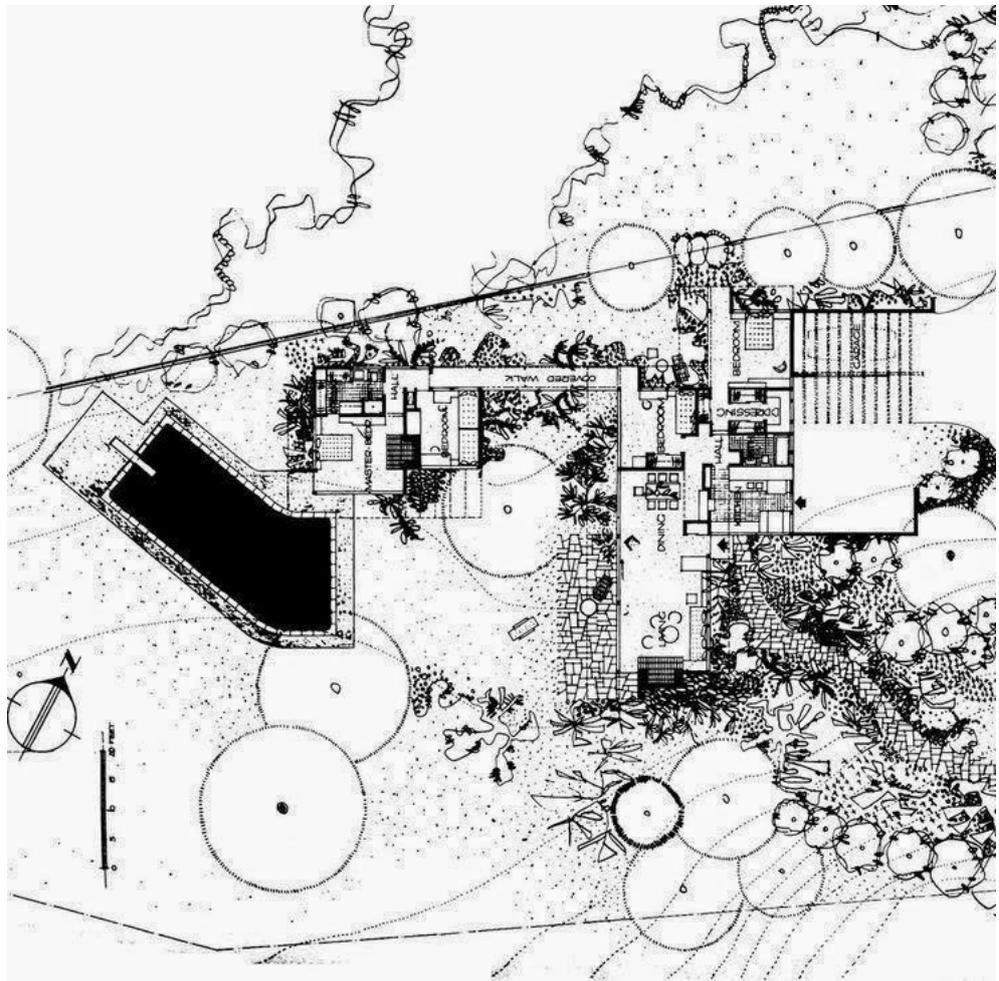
Planta con ampliación de la Bailey House, Los Ángeles 1946-1948.
